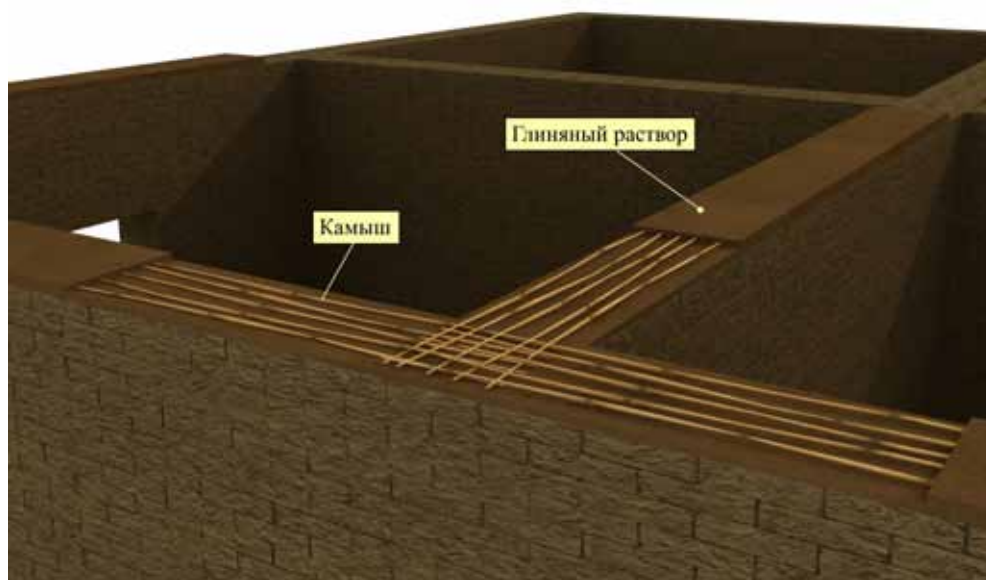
Армирование наружных и внутренних стен из сырцового кирпича и глинобита камышом
